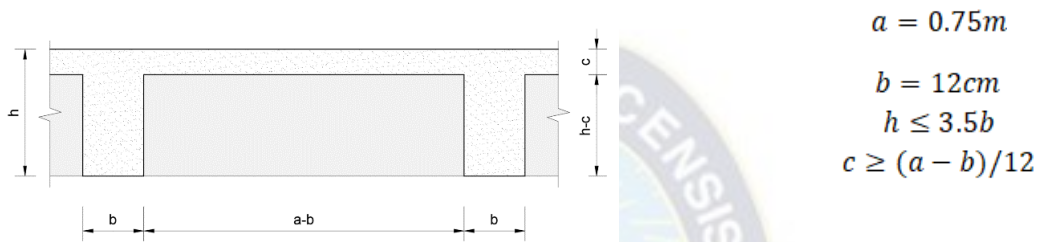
Predimensionamiento Losa post-tesado Aligerada - Fuente: Elaboración propia
